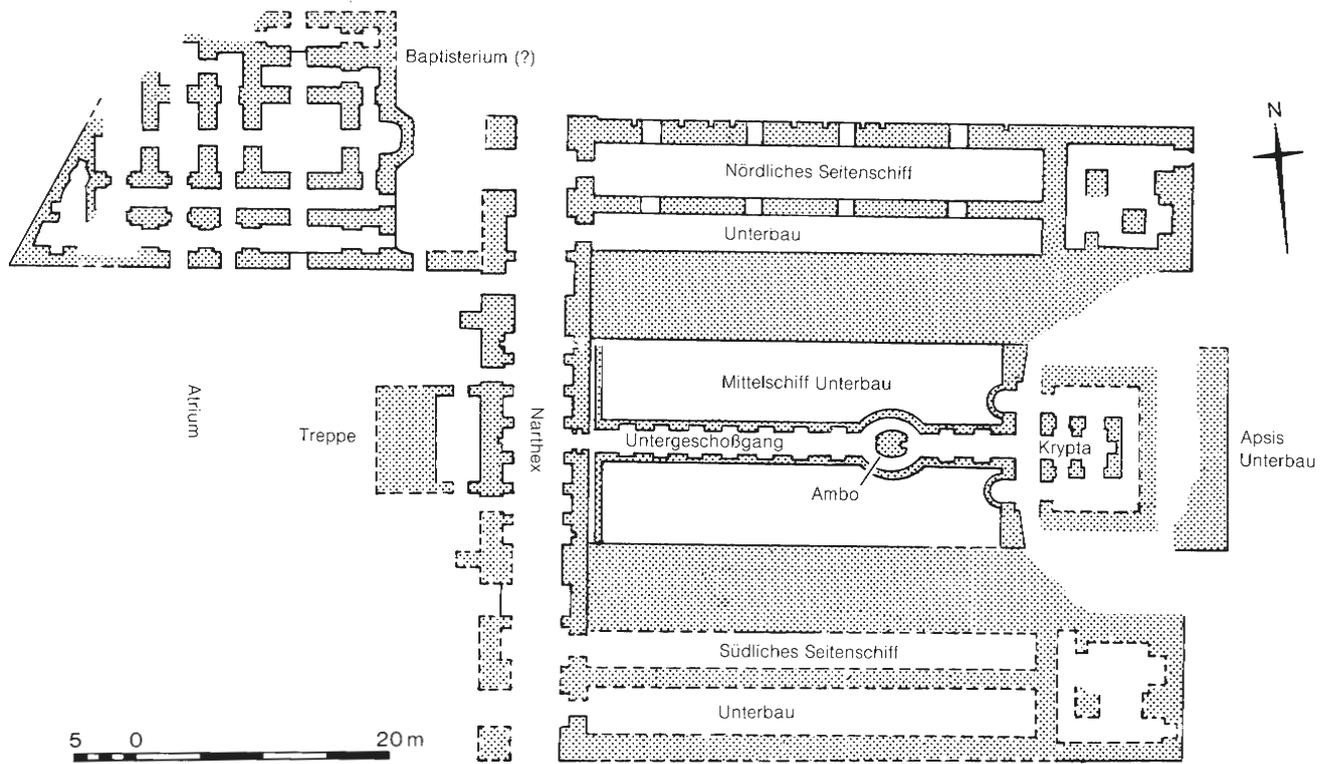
Rekonstruierter Grundriss der Polyuktoskirche und ihrer Nebenkirche. – (Nach Harrison, Tempel Abb. 48)
